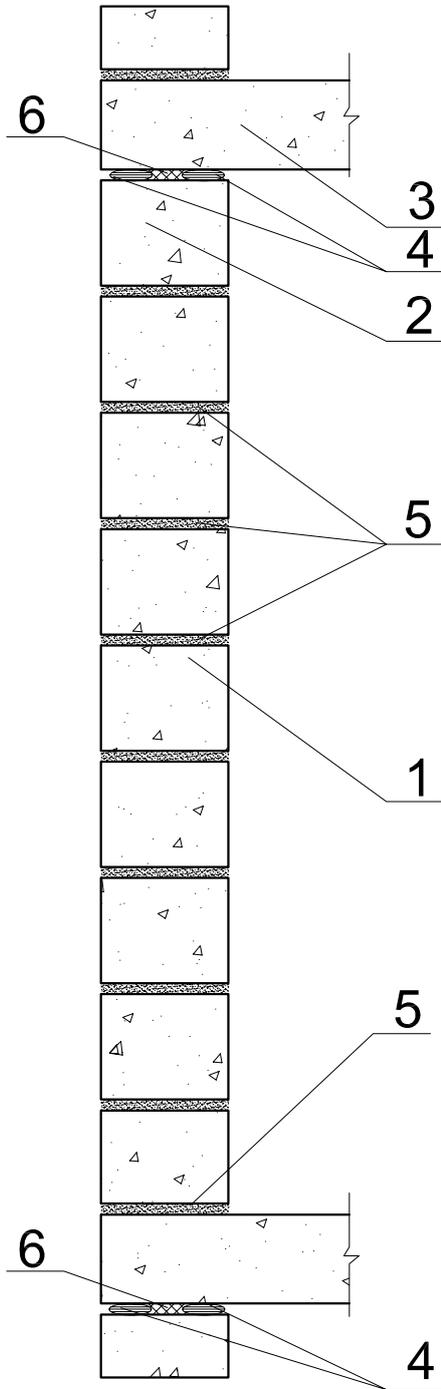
Сопряжение кладки наружной стены из двух разнотипных блоков с внутренней стеной
